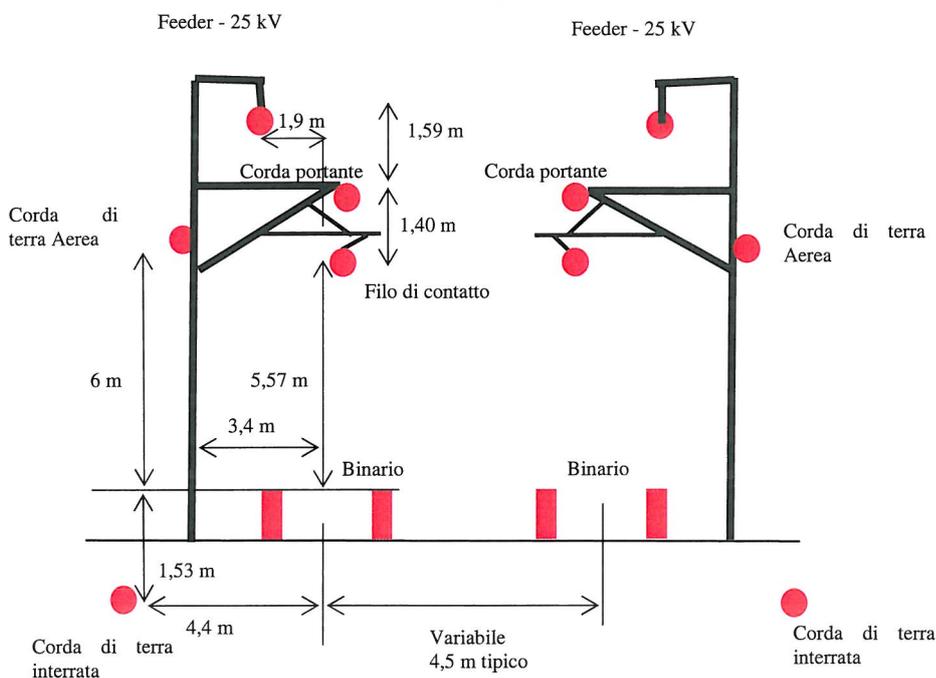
Disposizione geometrica delle condutture degli impianti di trazione
